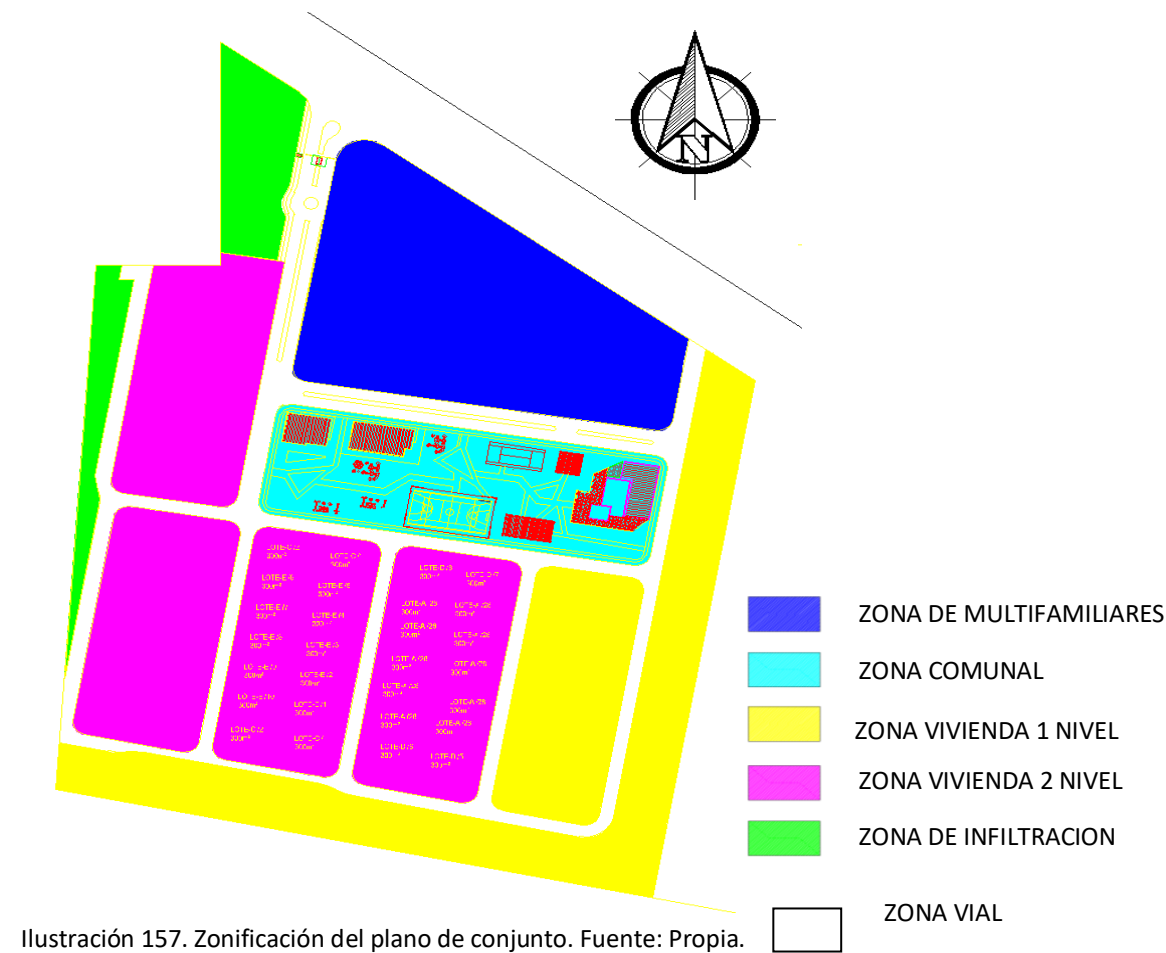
Zonificación del plano de conjunto. Fuente: Propia.
